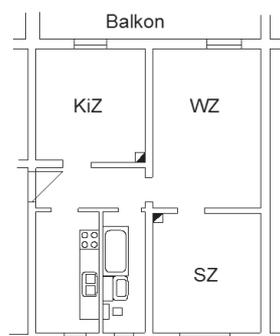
Wohnung im MFH - Grundriss (Quelle: Th. Hartmann)
